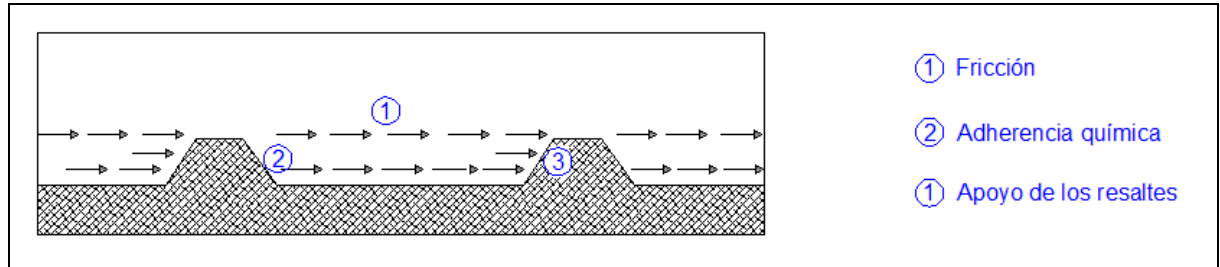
Características de adherencia en el concreto reforzado.
